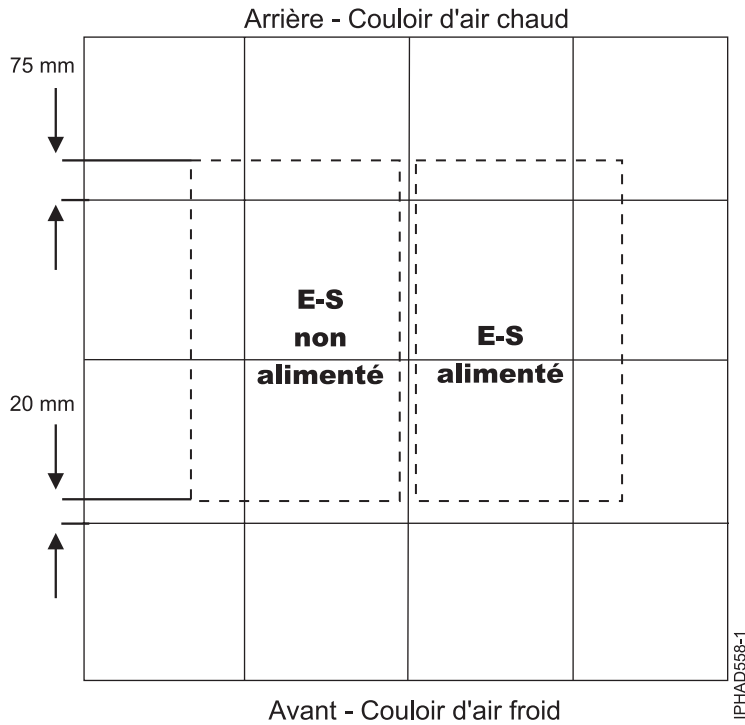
Positionnement de deux armoires pour dalles de plancher de 610 mm
